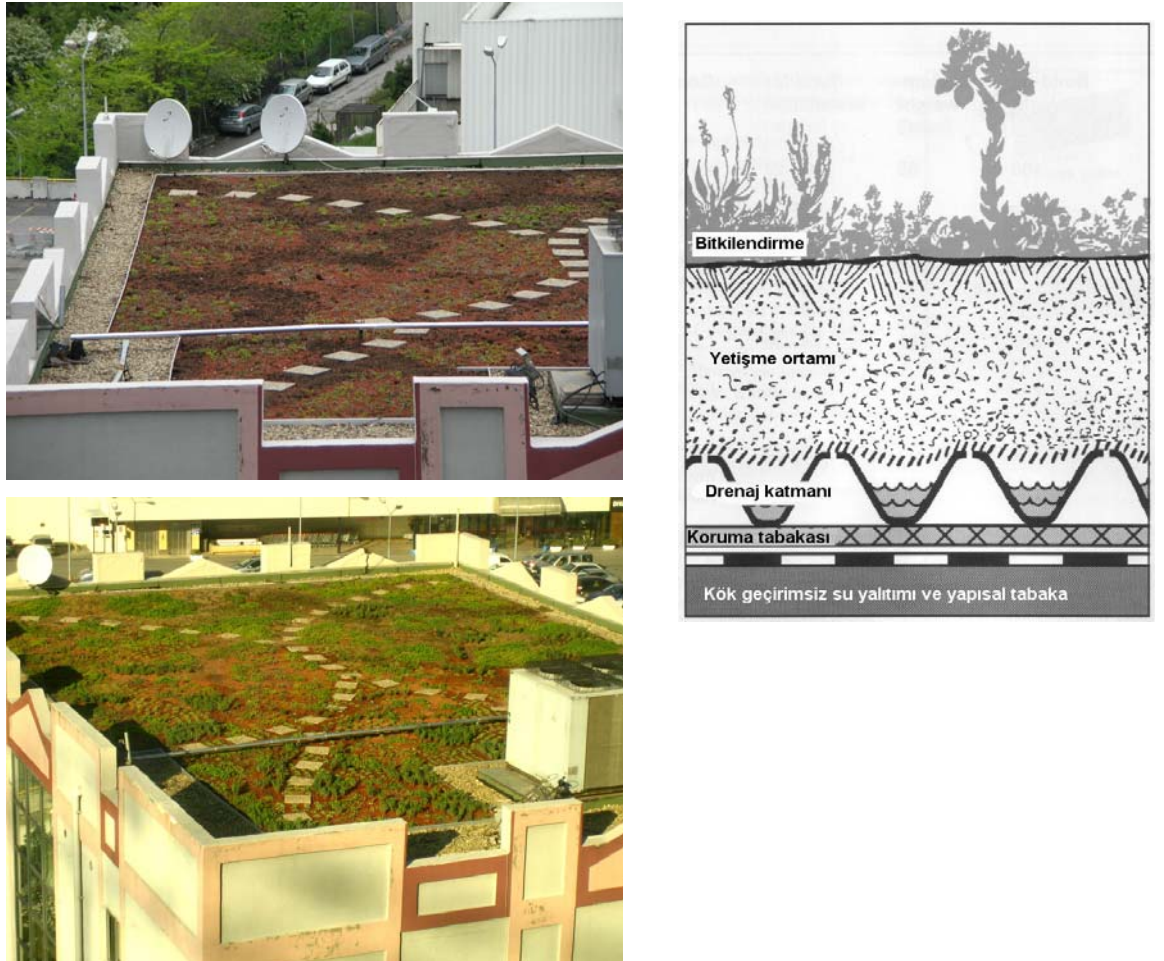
Bahçedeki drenaj ve su yalıtımı.
